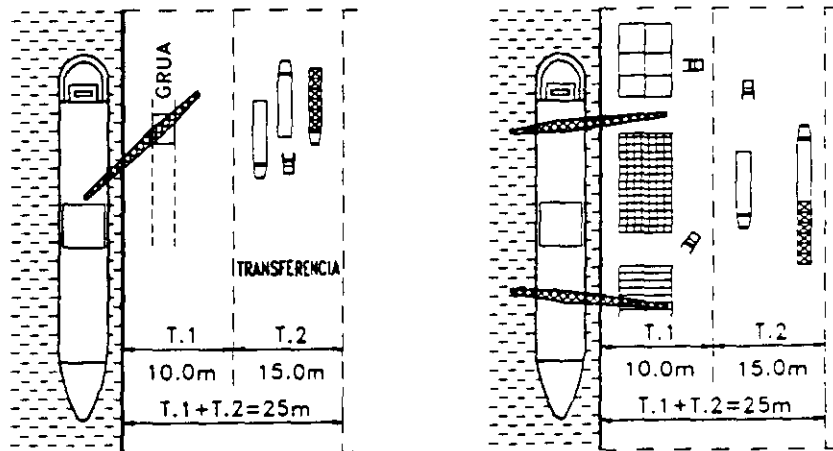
Ancho de cubierta del muelle (T.1 y T.2)
